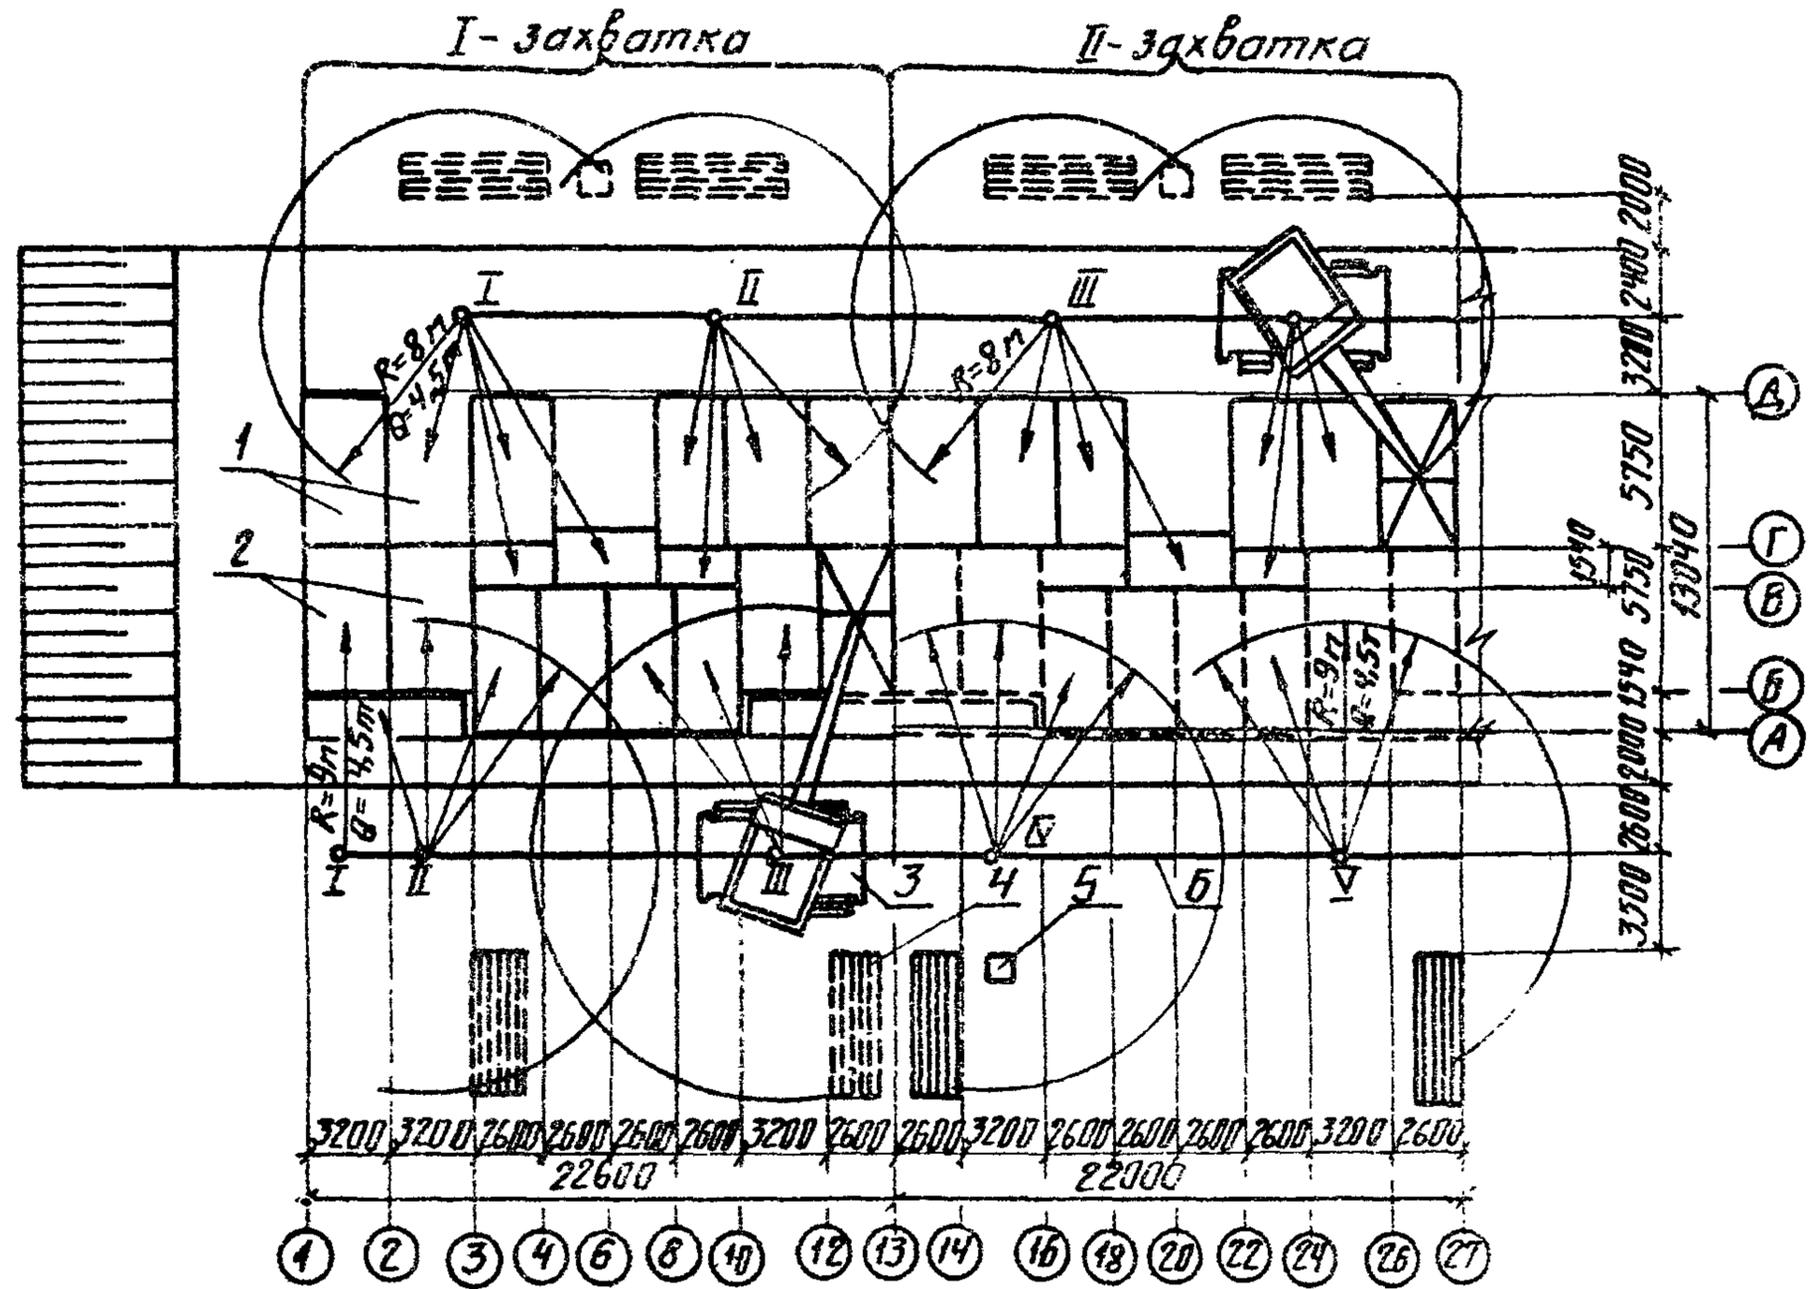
Схема организации работ по монтажу панелей перекрытия технического подполья: 1-панели смонтированные краном № 1; 2-панели смонтированные краном № 2; 3-двухколесный кран К-161; 4-панели в кассетах; 5-ящик для раствора; 6-ось движения крана; I, II, III, IV, V - стоянки крана
